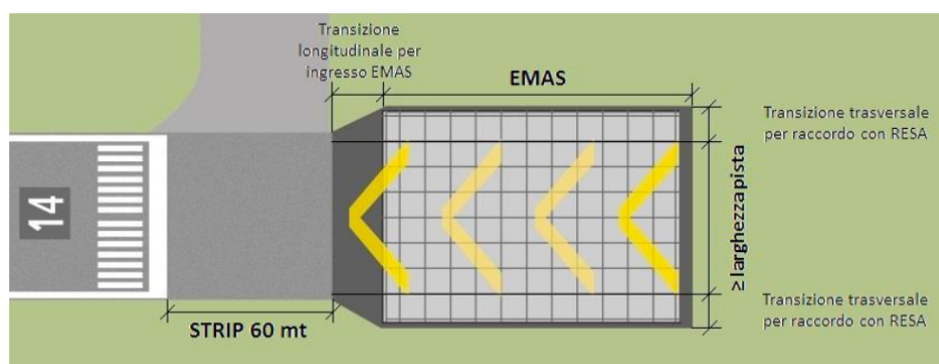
Vista dall'alto di un EMAS e della distanza di setback (ENAC, Linee guida per la progettazione, l'installazione ed il collaudo dei letti di arresto (EMAS))
